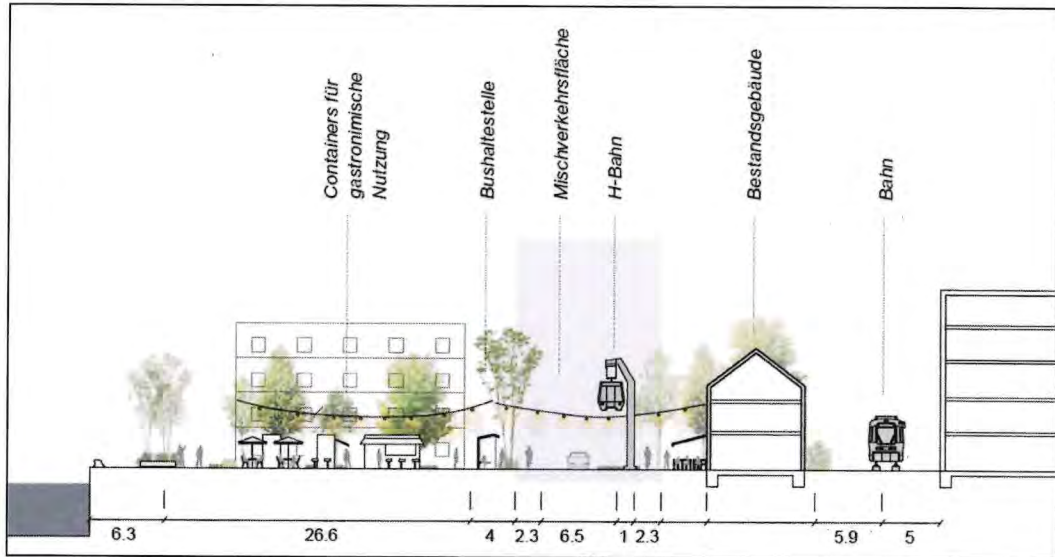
Geplanter Straßenquerschnitt Speicherstraße Höhe Siloplatz (Cobe Architects, 2023)
